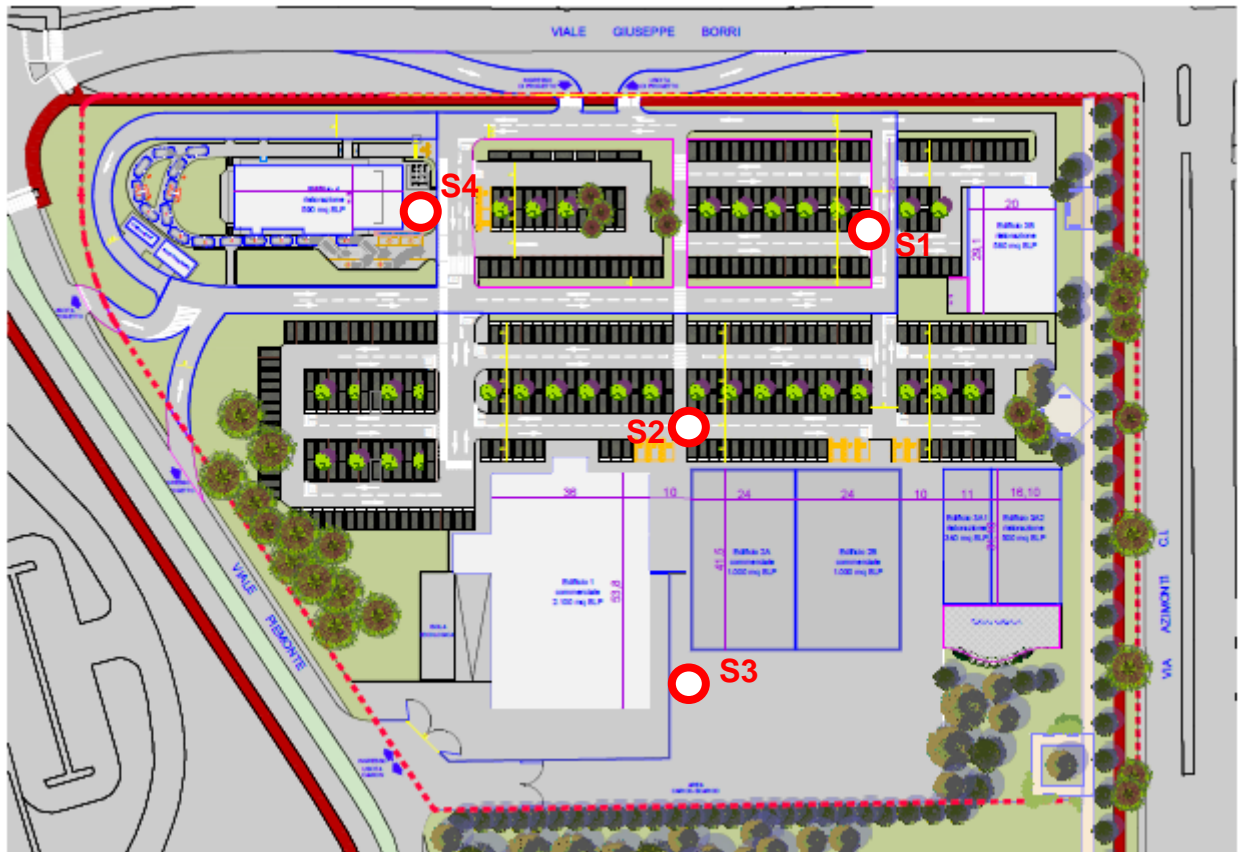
planimetria con ipotesi di progetto e ubicazione punti di prova di scavo (scala 1:2000)
